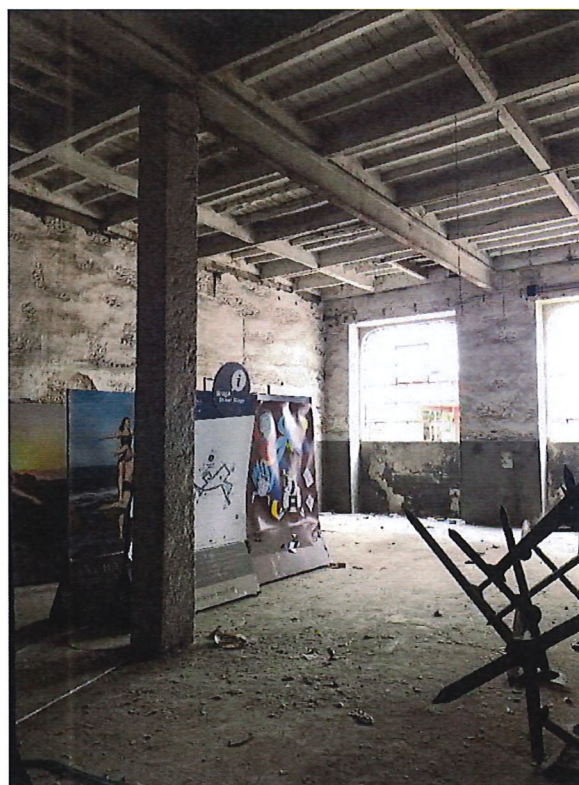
| Interior – Estrutura de betão e pavimentos em madeira
